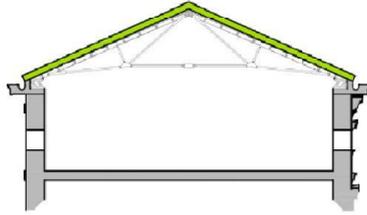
Sección transversal indicando las capas de cubierta.
